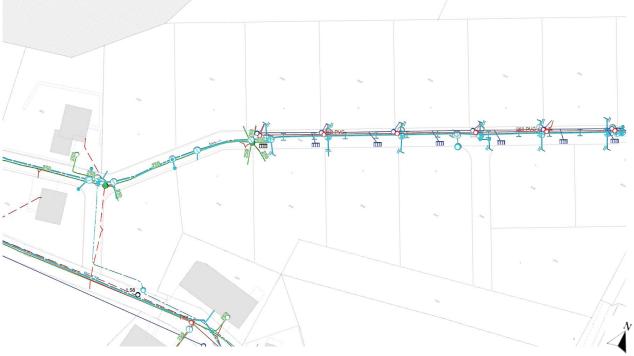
Plan des conduites souterraines réalisées au 05.03.2019 : eau potable, eaux claires et eaux usées, téléphone, électricité. (Source : SITN)
